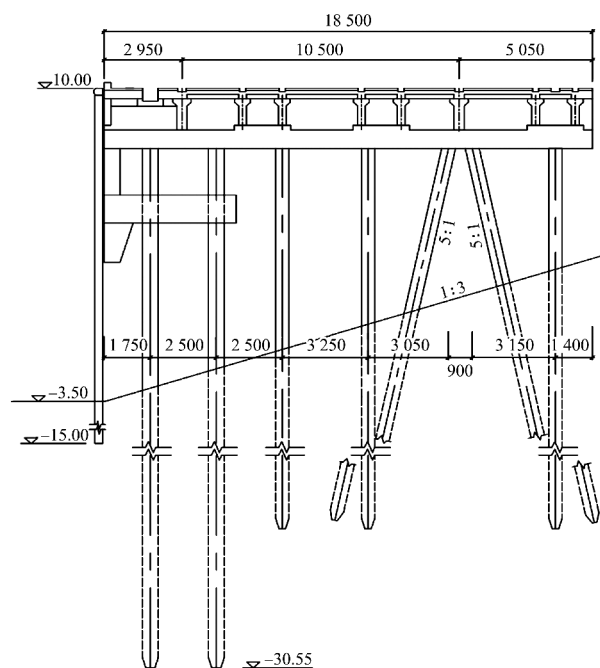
码头结构剖面 (尺寸: mm; 高程: m)
